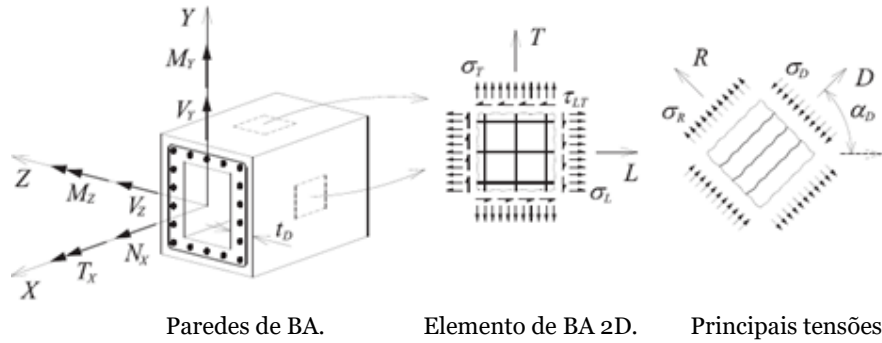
Idealização de uma viga de betão armado pelo CA-STM.
